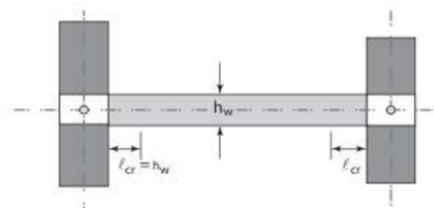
Zones critiques d'extrémité d'une poutre primaire
